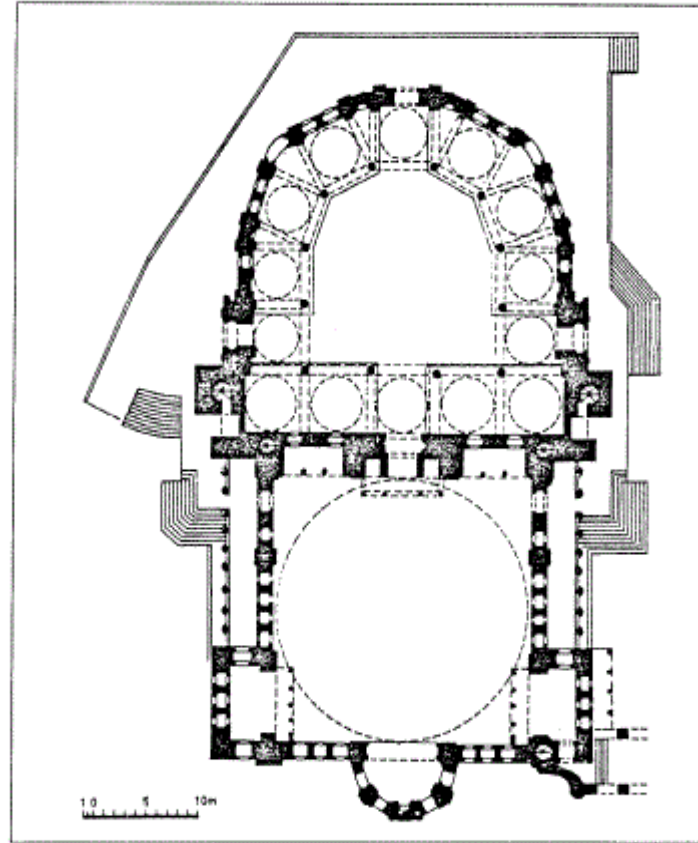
مكرر) مسقط أفقي لمسجد بايزيد الثاني في ادرنة (عن: Mūderrisoğlu).
